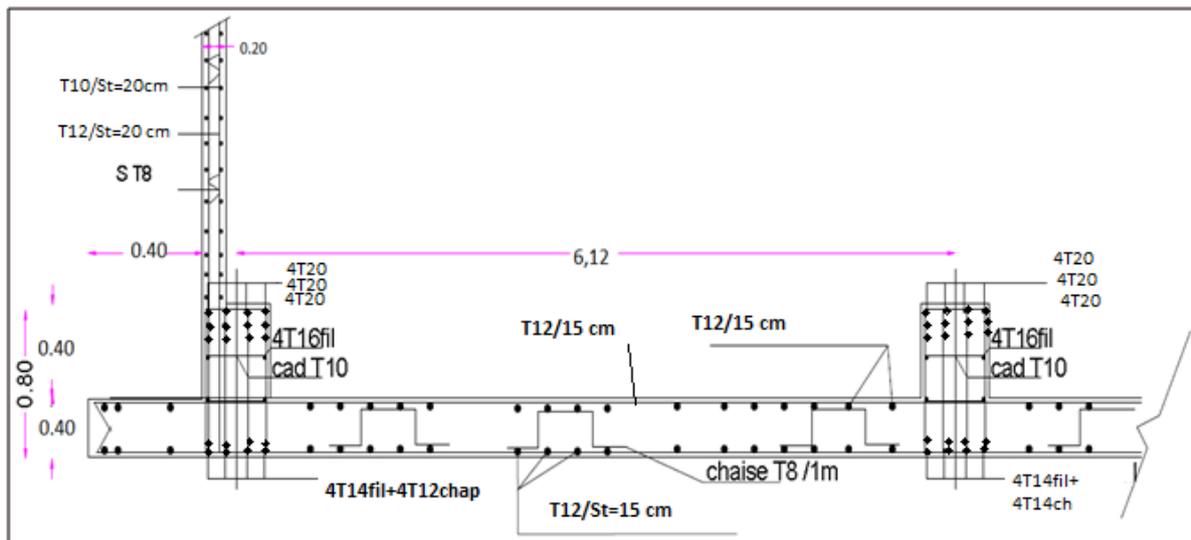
Ferrailage de la poutre de libage et le radier et voile périphérique suivant le sens longitudinale
